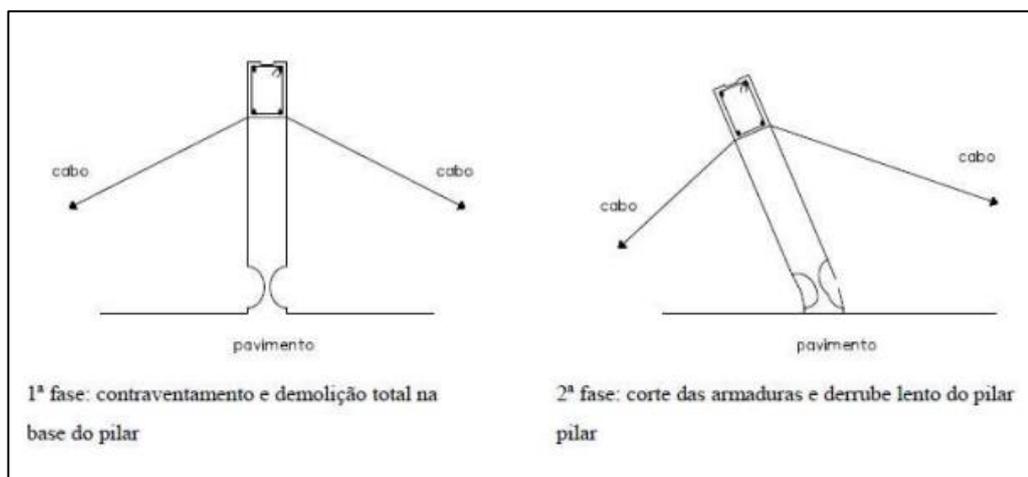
Demolição de Pilares. (fonte: BRITO, 1999)
